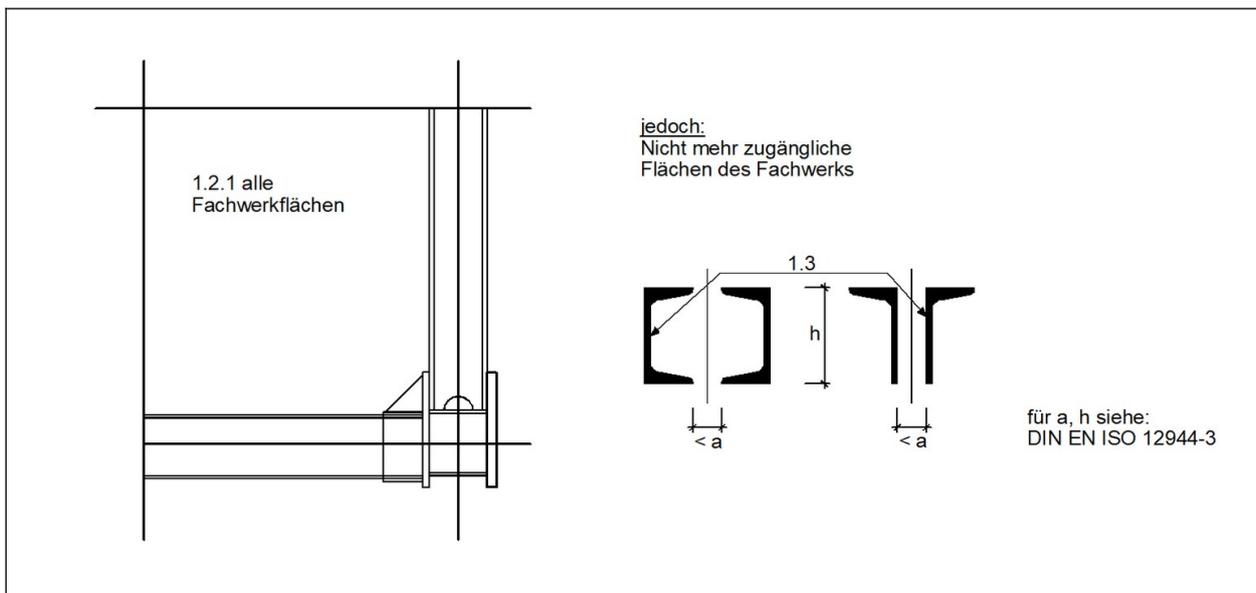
Teilquerschnitt einer Fachwerkkonstruktion
